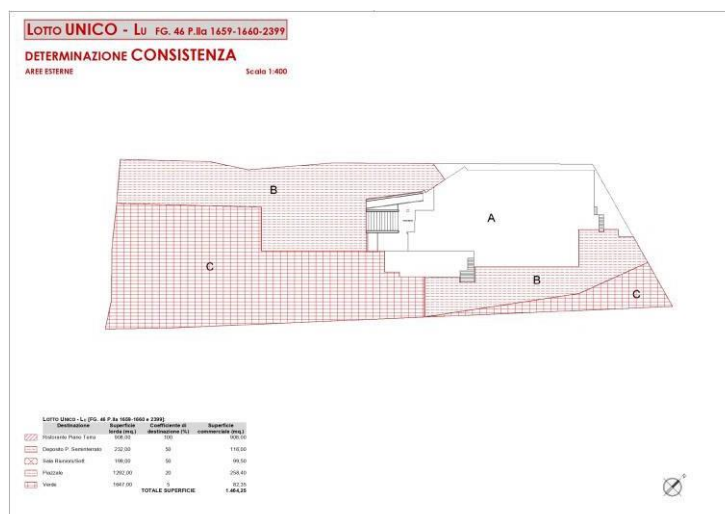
Determinazione consistenza Lotto LU – P. 3. (ALL. 10).
